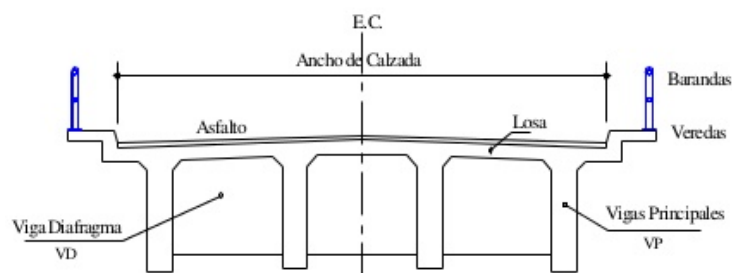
Vista de la sección transversal con disposición de barandas y veredas
